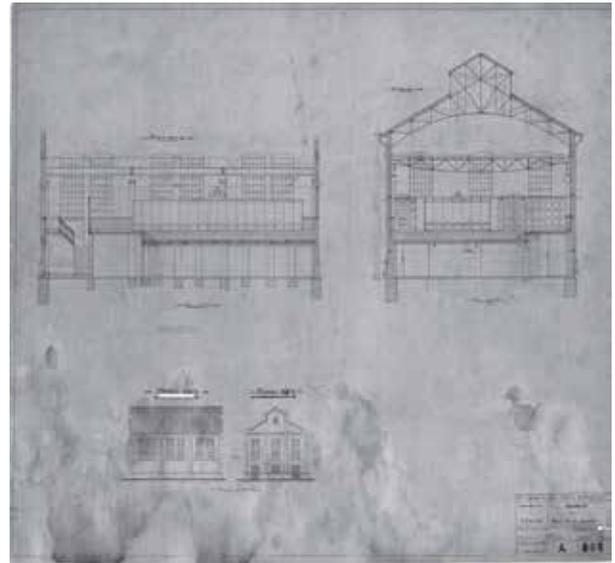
Plano A-866 "Proyecto para Nueva Planta Eléctrica", Monterrey, N.L., 11 septiembre 1912. Contrato 28646. AHF.
